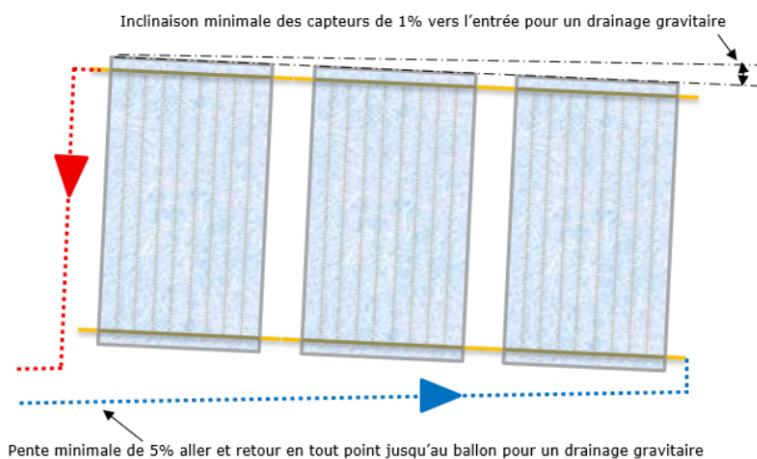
Installations auto-vidangeables – inclinaison nécessaire – Capteur CEV
